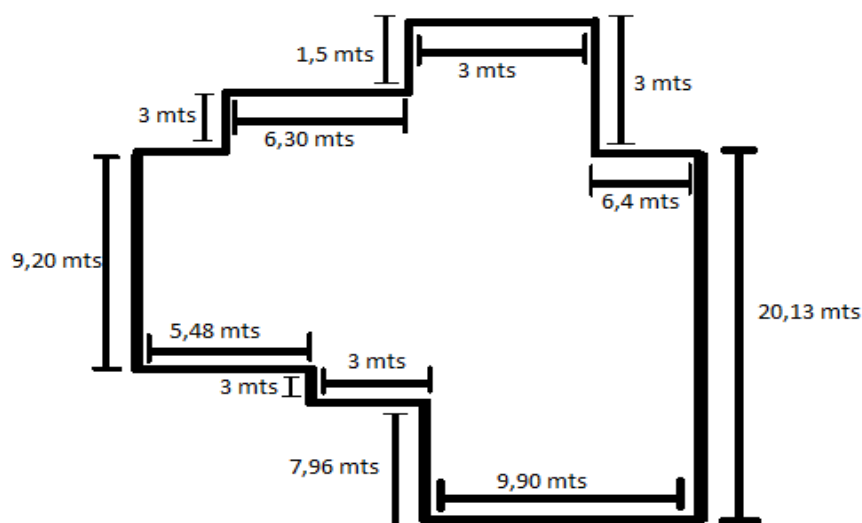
Área vivienda nueva de tres niveles construida en el predio denominado “Casa Amarilla o Las Gaviotas”. Área Total tomada del primer piso.
